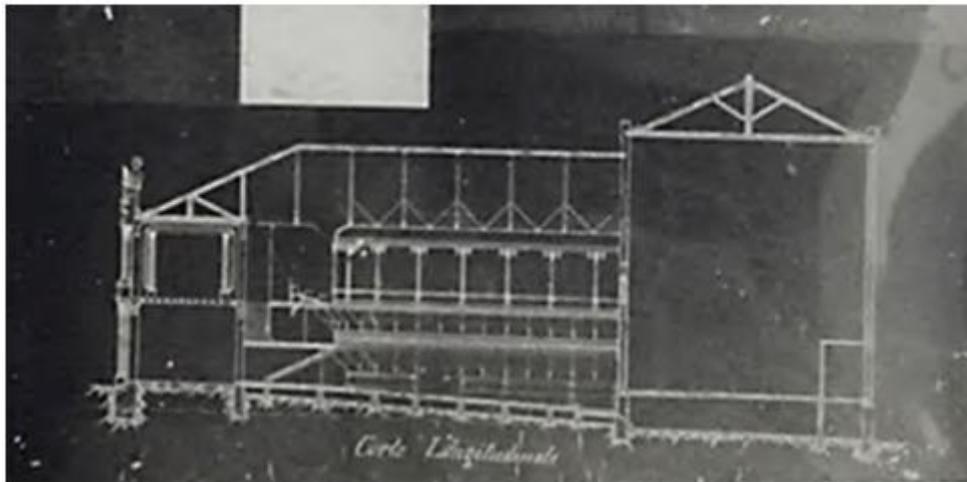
, 2 e 3 – Desenho da fachada, planta do térreo e corte transversal do Theatro Municipal de São João da Boa Vista– (c.1913).
